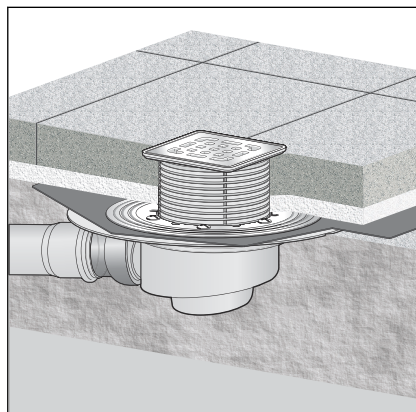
Exemplo de montagem geral – Reentrância na laje
